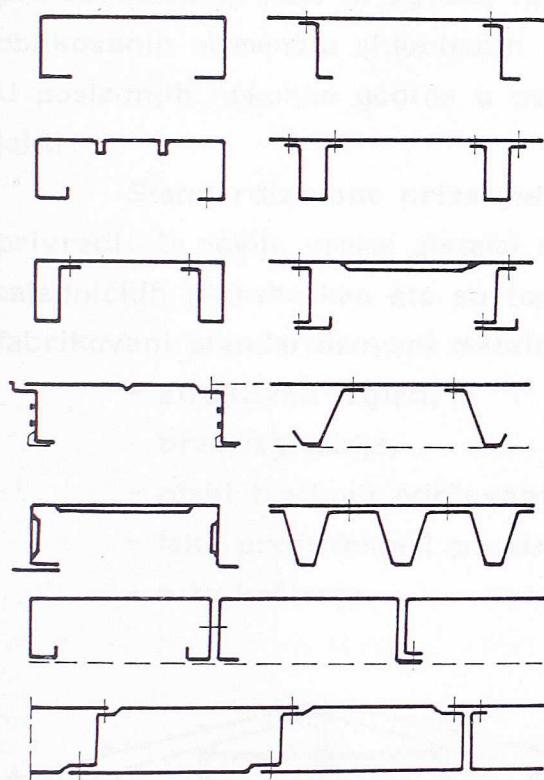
Upotreba HOP za sekundarnu noseću konstrukciju hala
